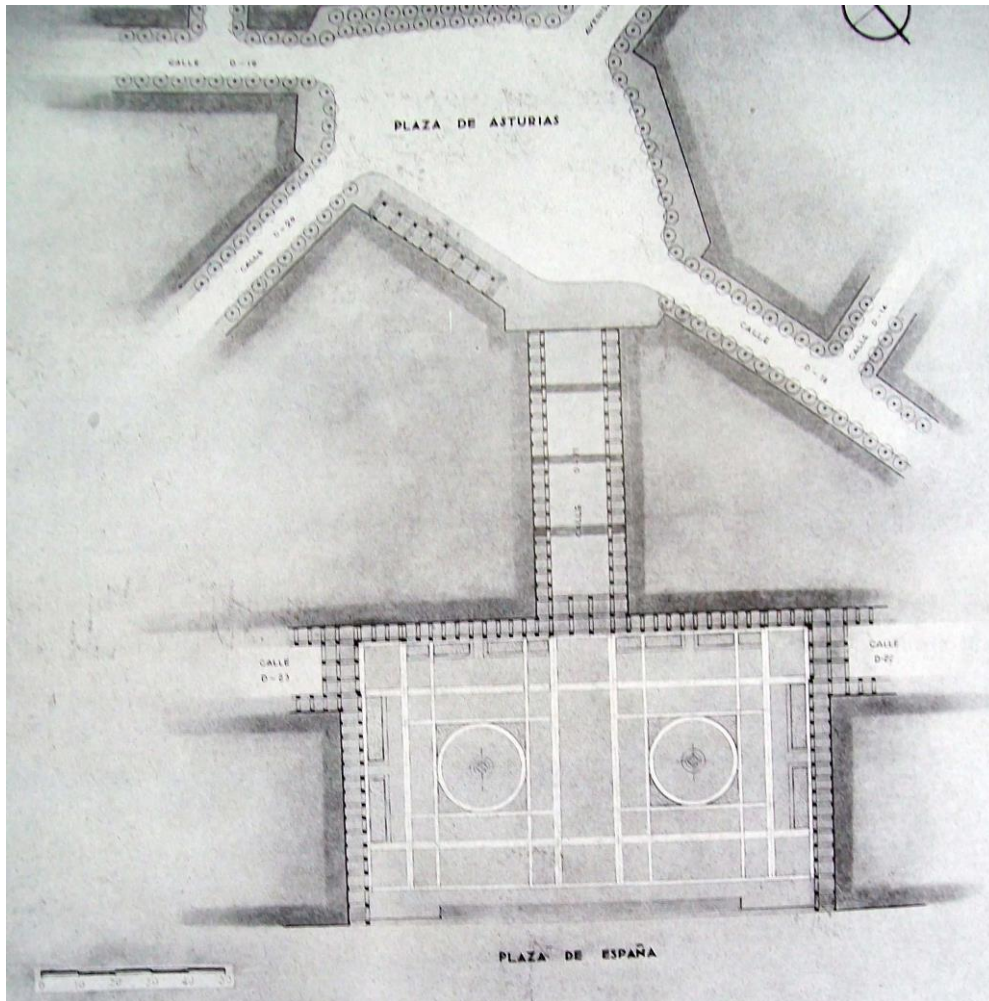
Plano del Plan Gamazo para las plazas de España y Asturias. AMO, Caja 530199, Sign. 11-1-50-3.
